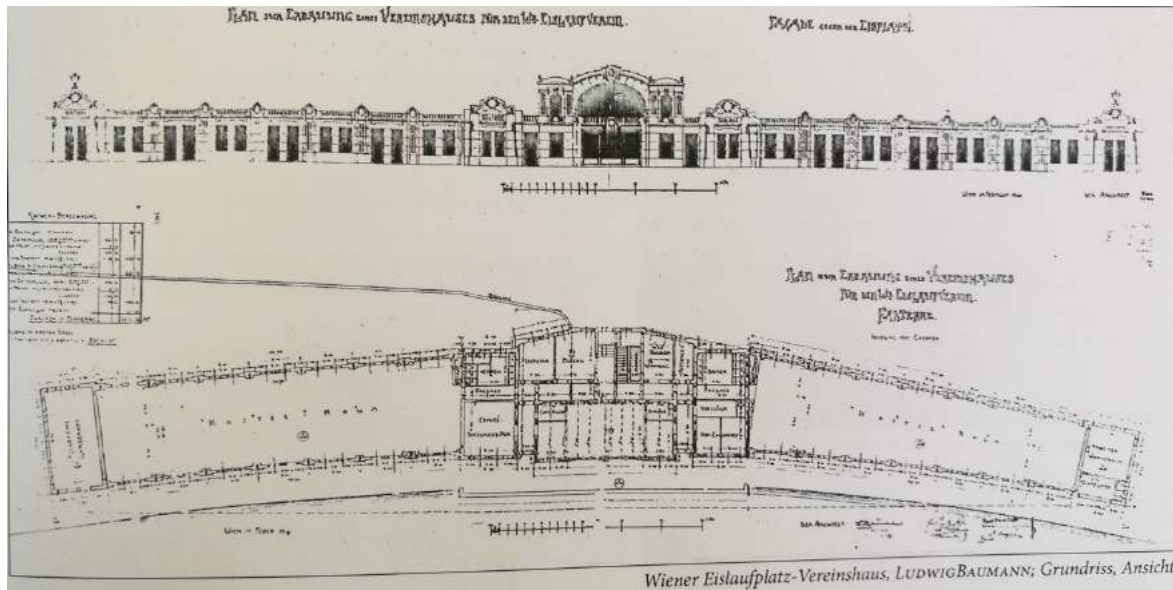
Grundriss und Ansicht der 1959 abgerissenen WEV Gebäude
